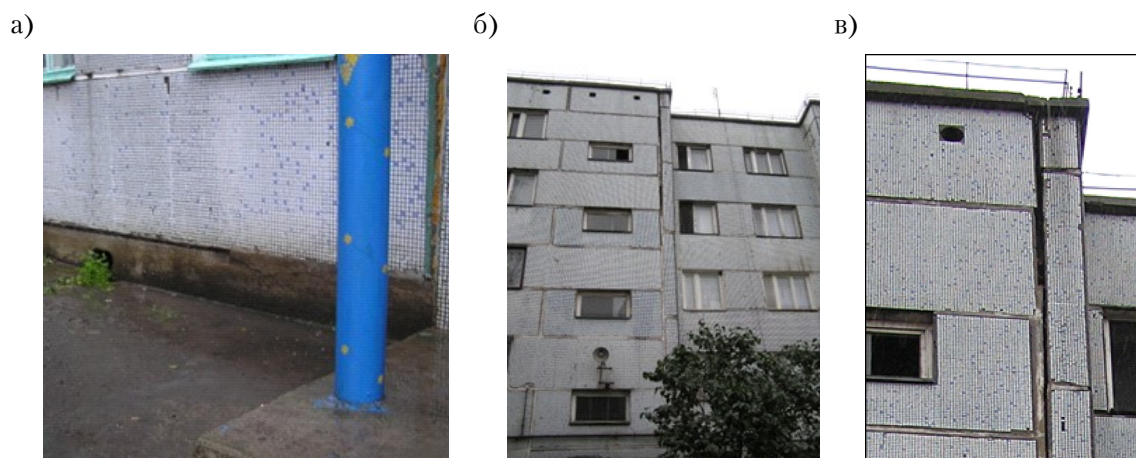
Пятиэтажный крупнопанельный жилой дом № 31 по ул. Мечникова в г. Курахово: а) асфальтобетонная отмостка либо разрушена, либо имеет уклон в сторону здания; б) трещины по стыкам панелей имеют ширину раскрытия до 60 мм в уровне 4–5 этажей; в) фрагмент фасада, с раскрытием трещин до 60 мм.
